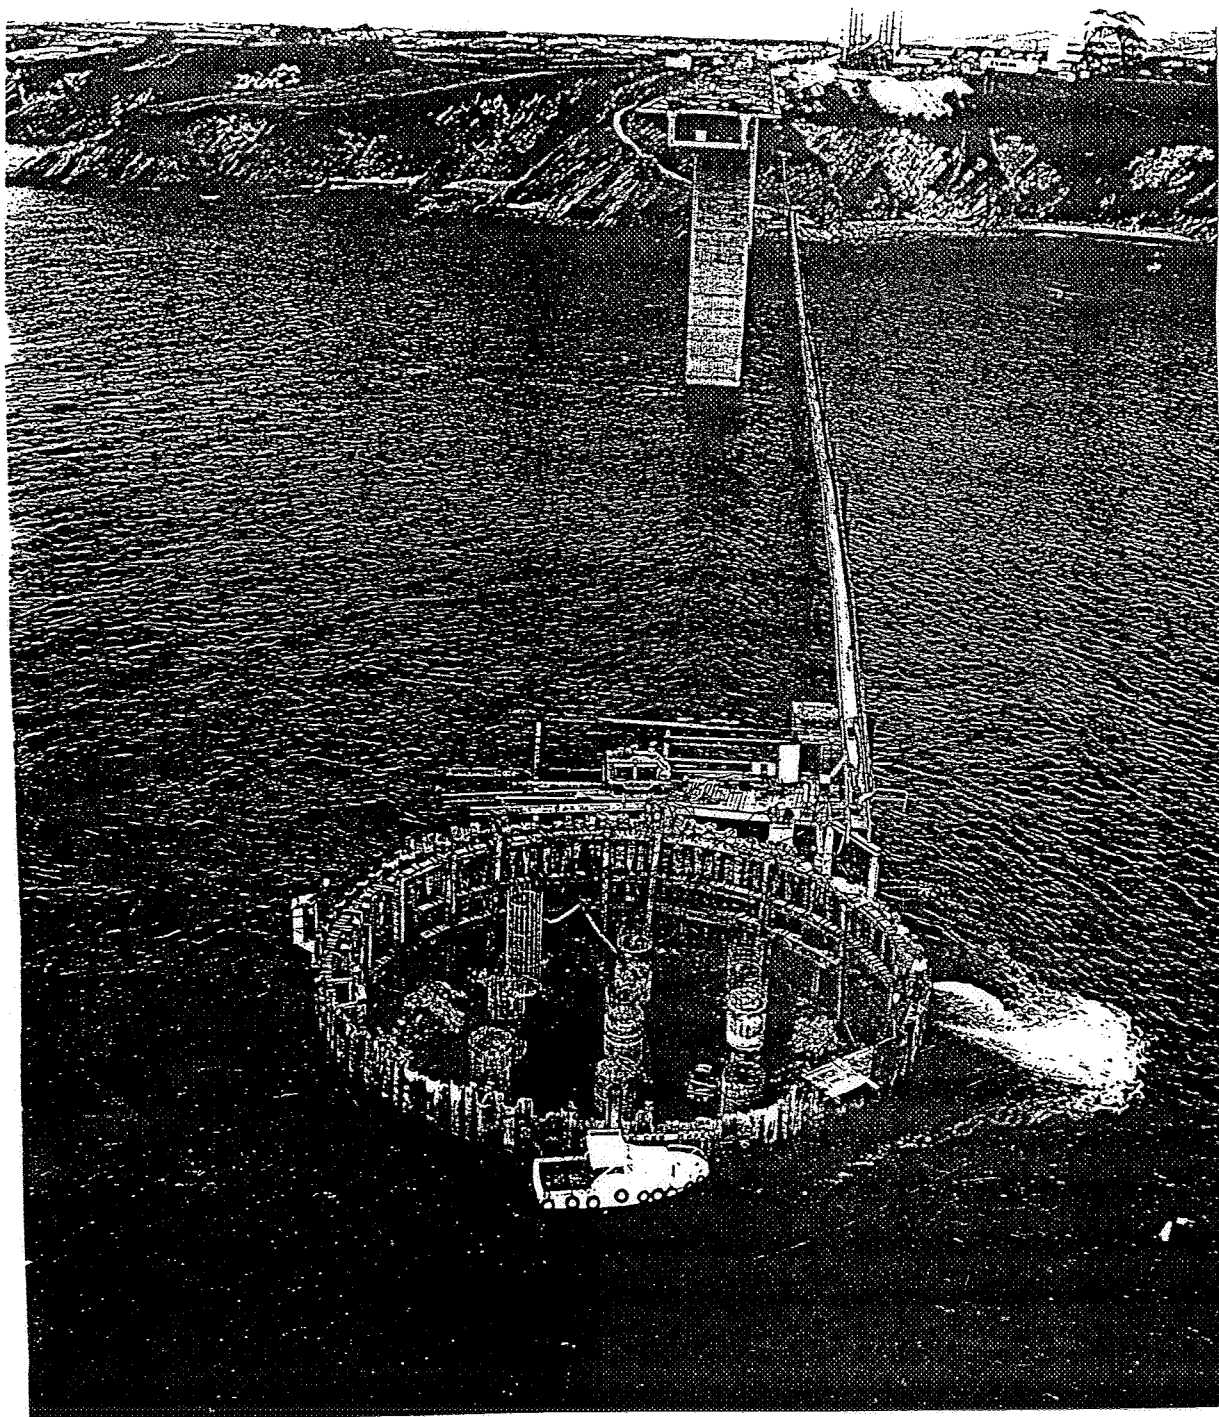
Recinto tablestacado construido para la ejecución de la cimentación del Puente de los Santos (Río Eo).
